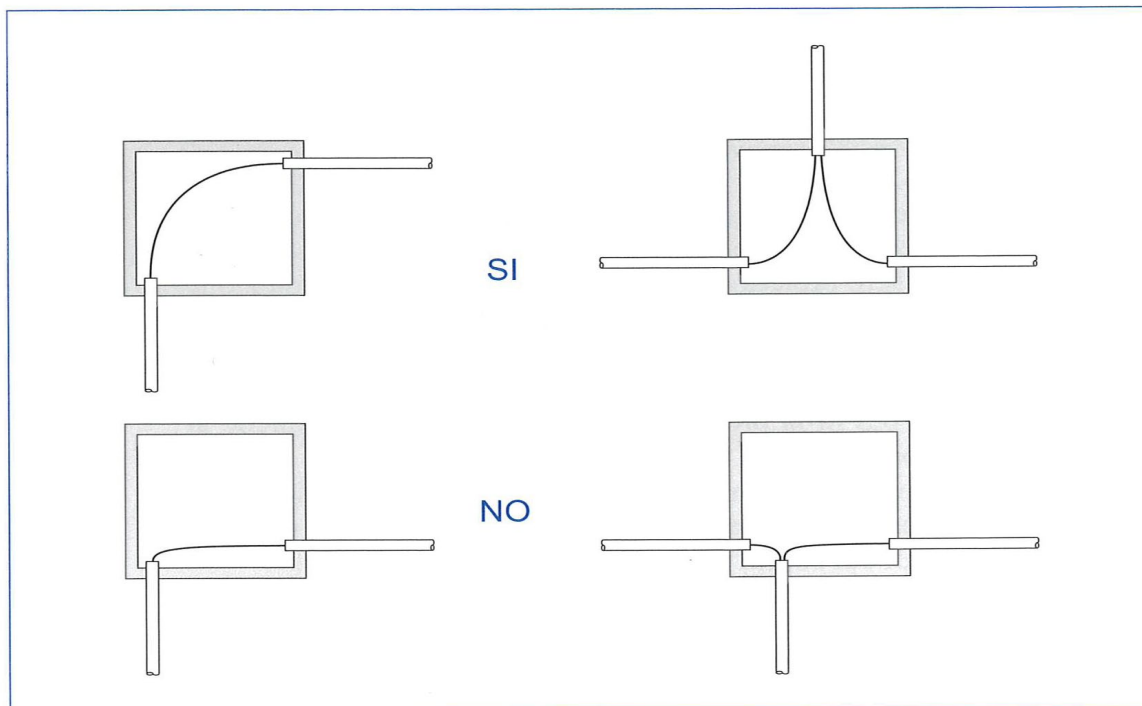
Nei cambiamenti di direzione la disposizione delle tubazioni e le dimensioni del pozzetto (visto in pianta nella figura) devono essere tali da rispettare il raggio minimo di curvatura dei cavi.
